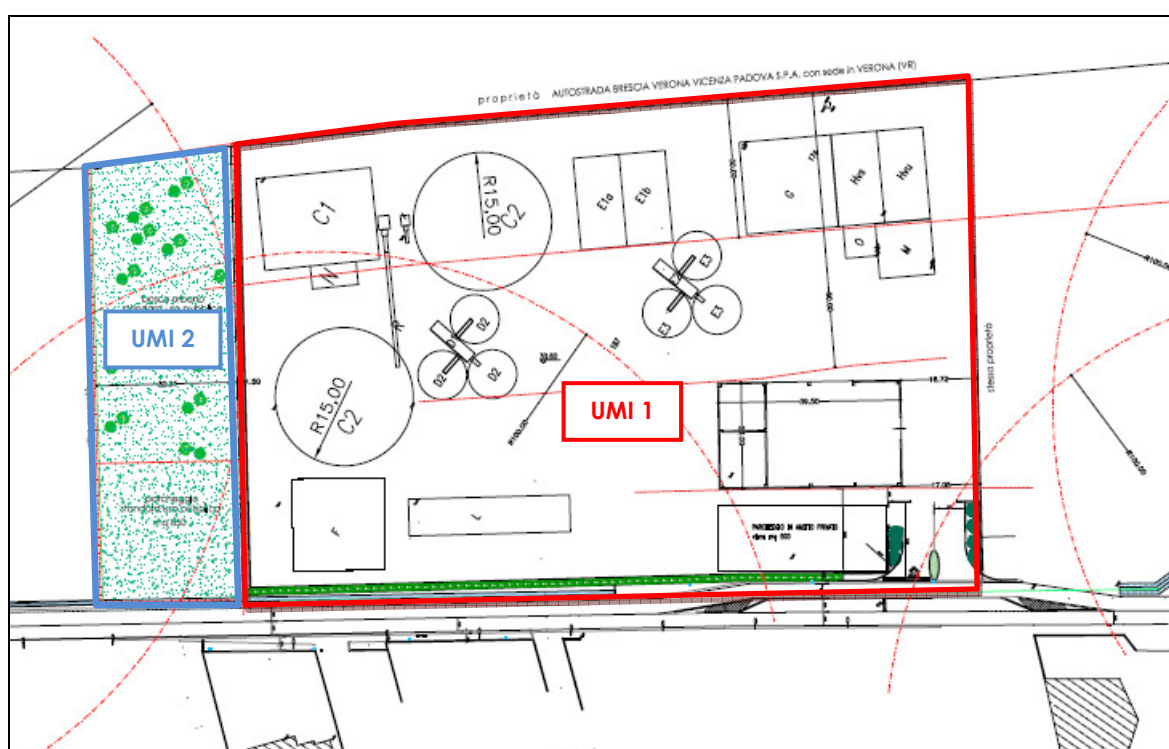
Planimetria di progetto: Elaborato 1A.
